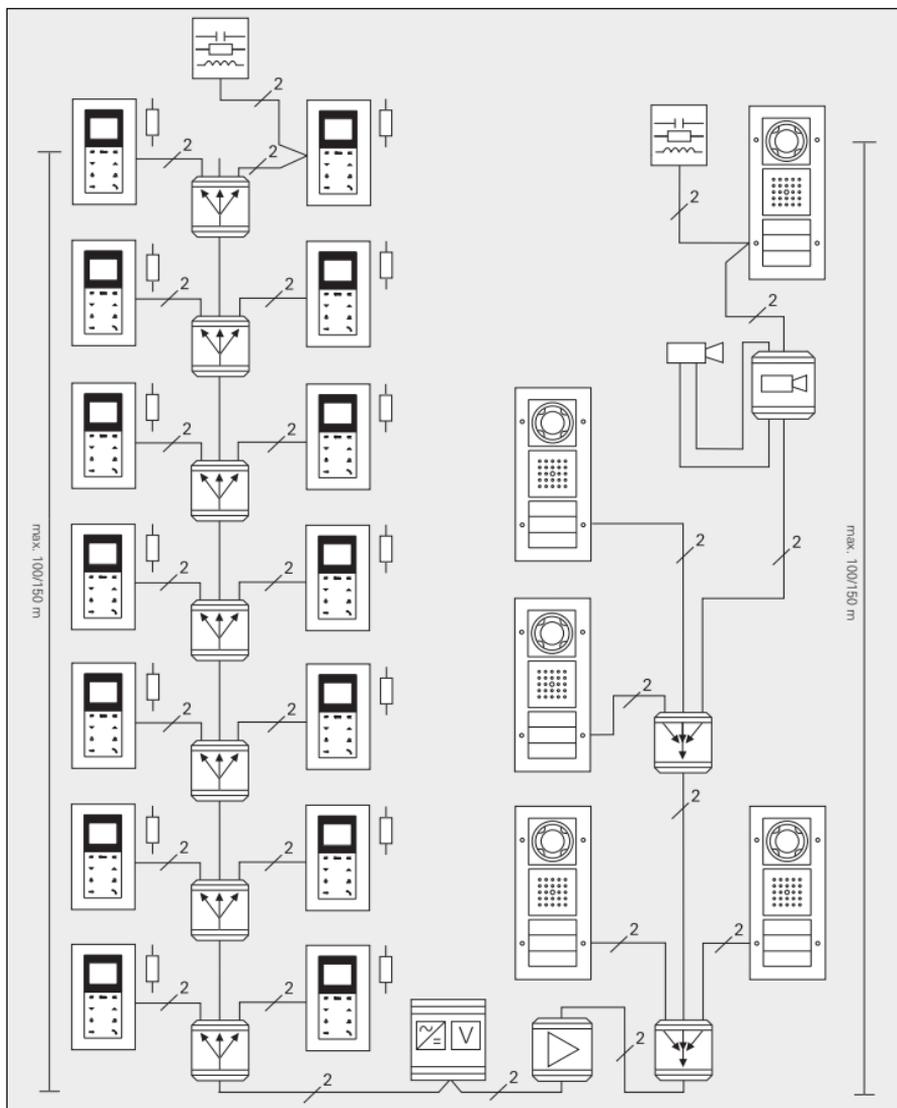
Installationsbeispiel mit TKS-Kamera-Gateway
